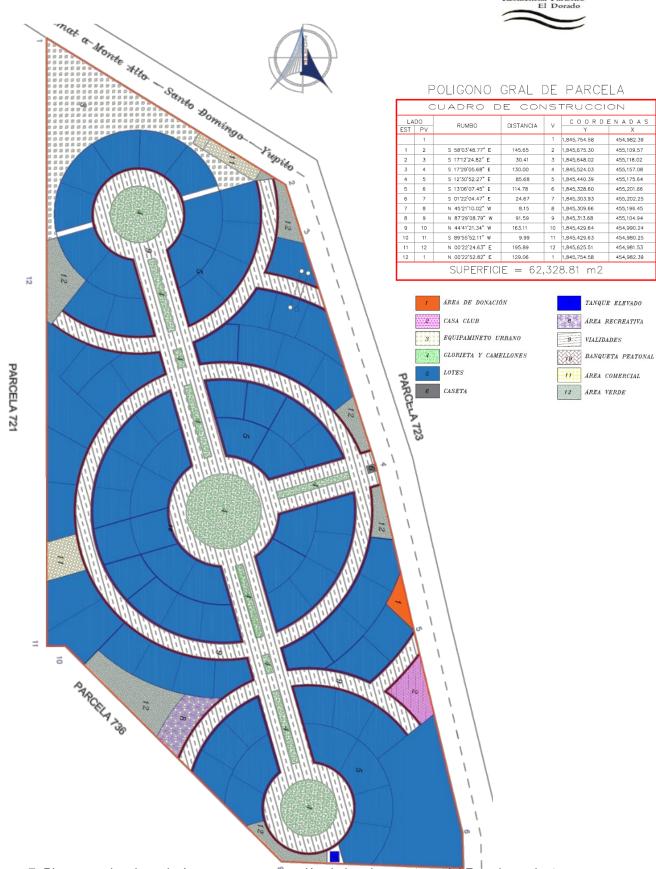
Plano con desglose de áreas para construcción de la primera etapa del Fraccionamiento
